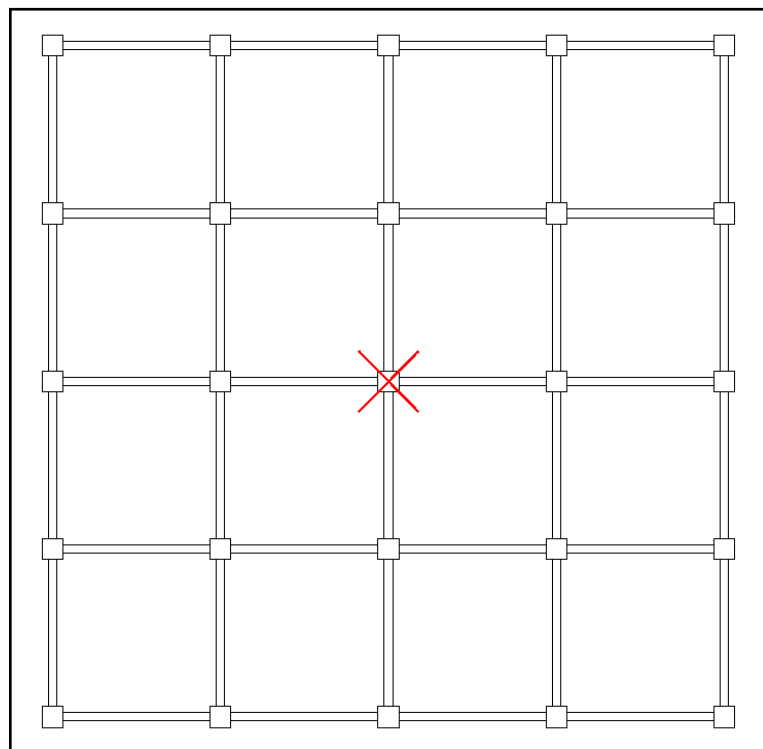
Planta baixa da edificação indicando o pilar removido.
